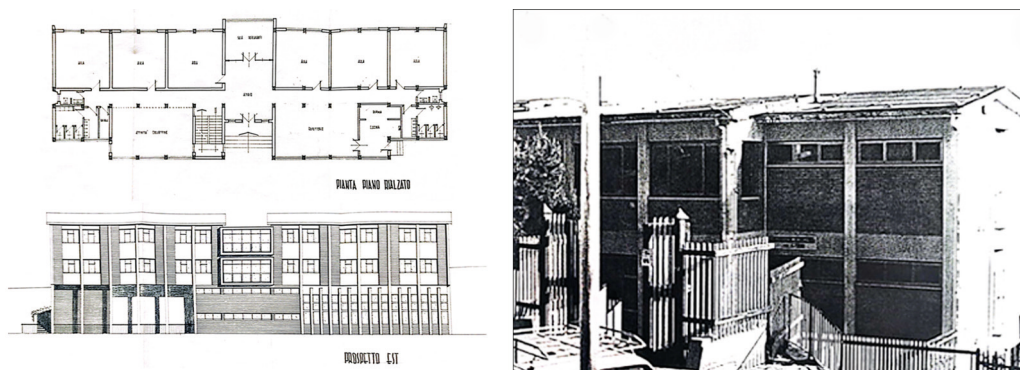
Collage di immagini. A sinistra: pianta e prospetto dell'I. C. *Aldo Moro* del progetto esecutivo, 1971 (fonte: Archivio di Stato, Matera); a destra: foto storica dell'edificio scolastico (fonte: Archivio comunale di Accettura).
